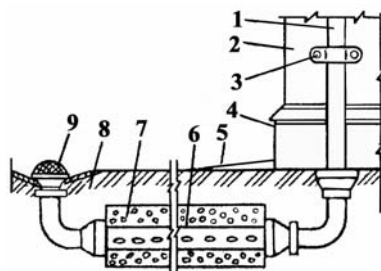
Слив дождевой воды с кровли под почву через дренажное устройство: 1 — водосточная труба; 2 — стена дома; 3 — скоба крепления трубы; 4 — цокольная часть стены; 5 — отмостка; 6 — дренажная труба с отверстиями; 7 — шлак; 8 — грунт основания; 9 — сетка воронки слива атмосферной воды
